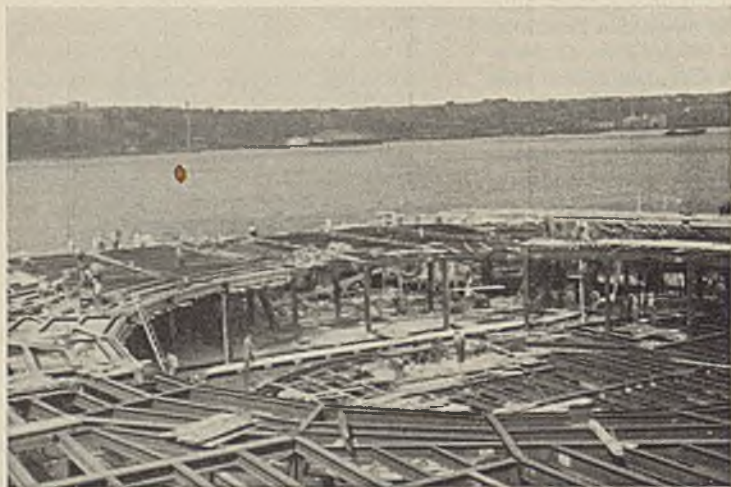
Neue Hudson-Ufer-Hochstraße. Dreistöckiger Rundbau als Stahlkonstruktion im Bau.
